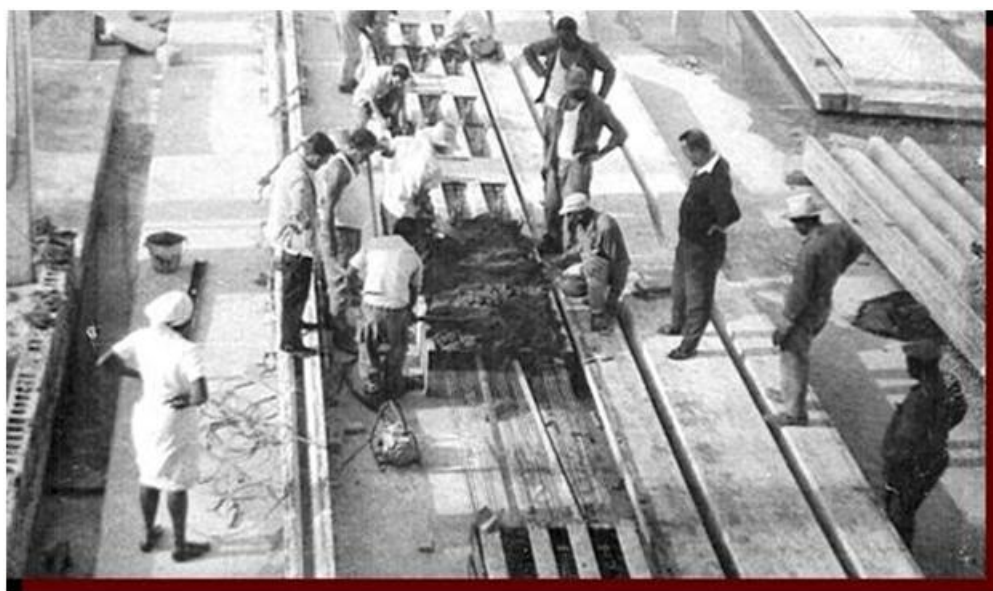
La primera producción experimental en moldes de hormigón de traviesas y losas Doble T (DT) pre-tensadas.
